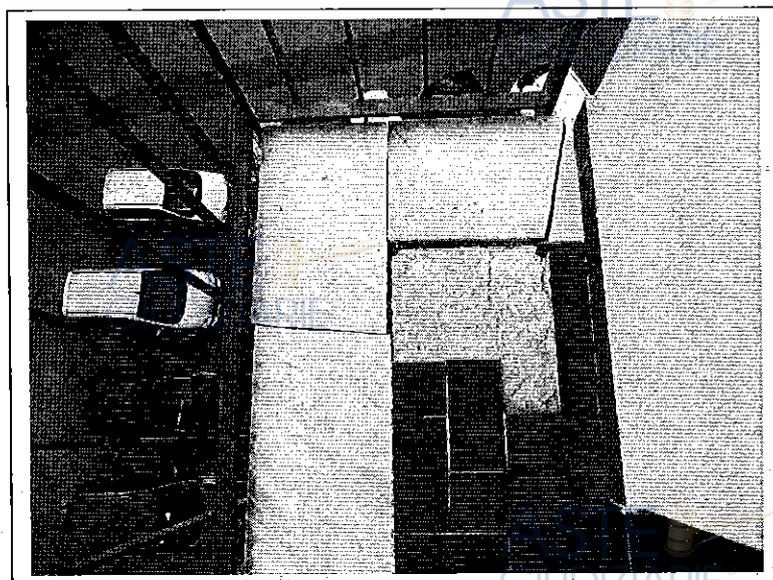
Immobile pignorato. Balcone prospiciente viale Michelangelo. Lastre di marmo rotte, sconnesse. Pavimentazione mancante.
